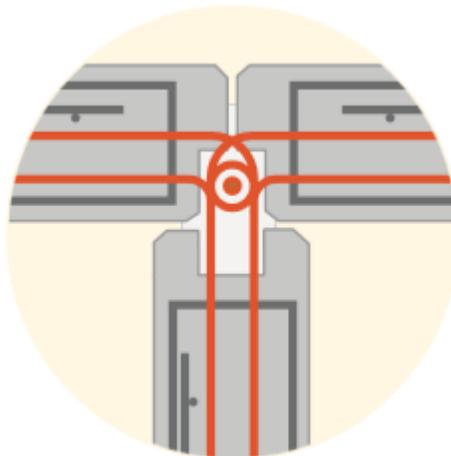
Unión Muro - Muro Fuente: Baumax
